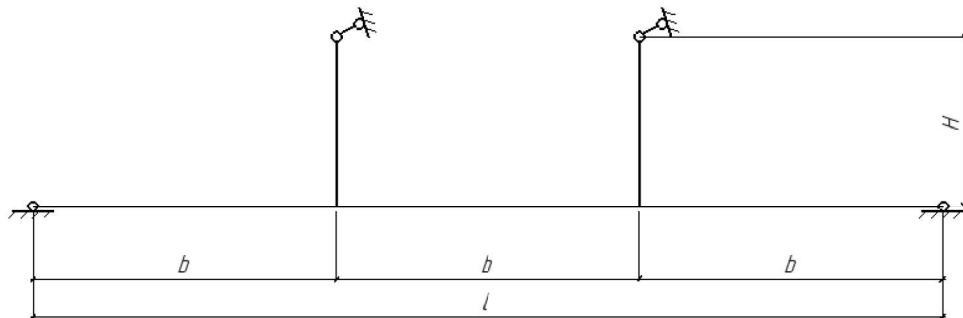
Расчетная схема нижнего пояса для расчета по методу № 3
